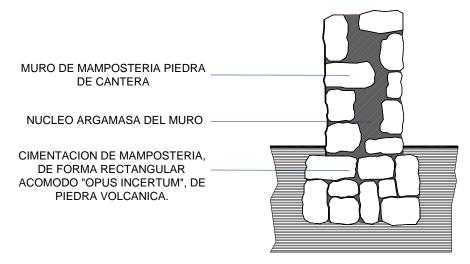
Detalle de la cimentación de mampostería rectangular.
